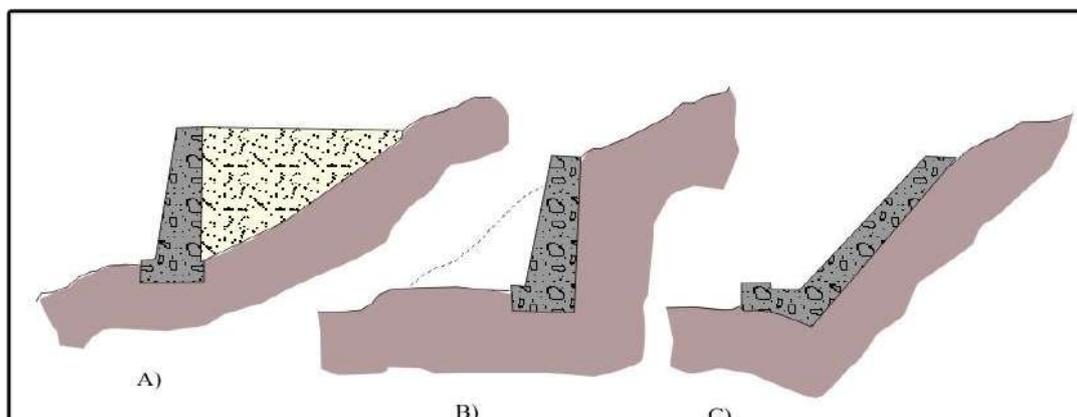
a) Muro de sostenimiento b) Muro de contención c) Muro de revestimiento.
